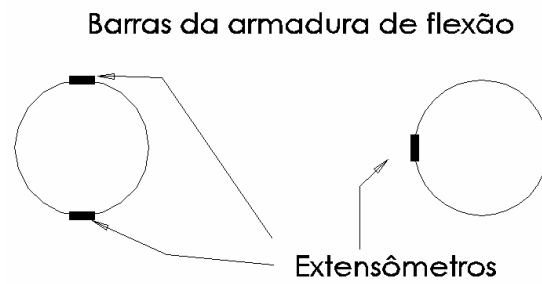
Posicionamento dos extensômetros elétricos nas barras da armadura de flexão
